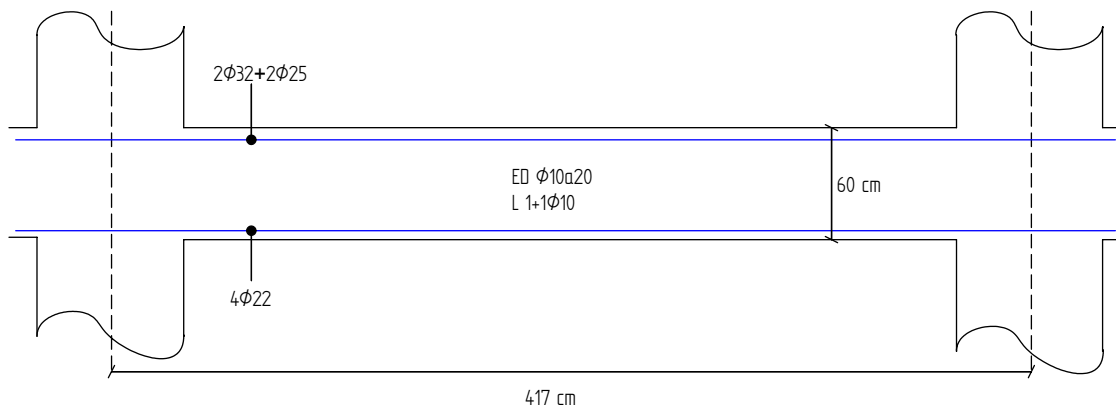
Armadura de viga V33 – Vista Longitudinal
